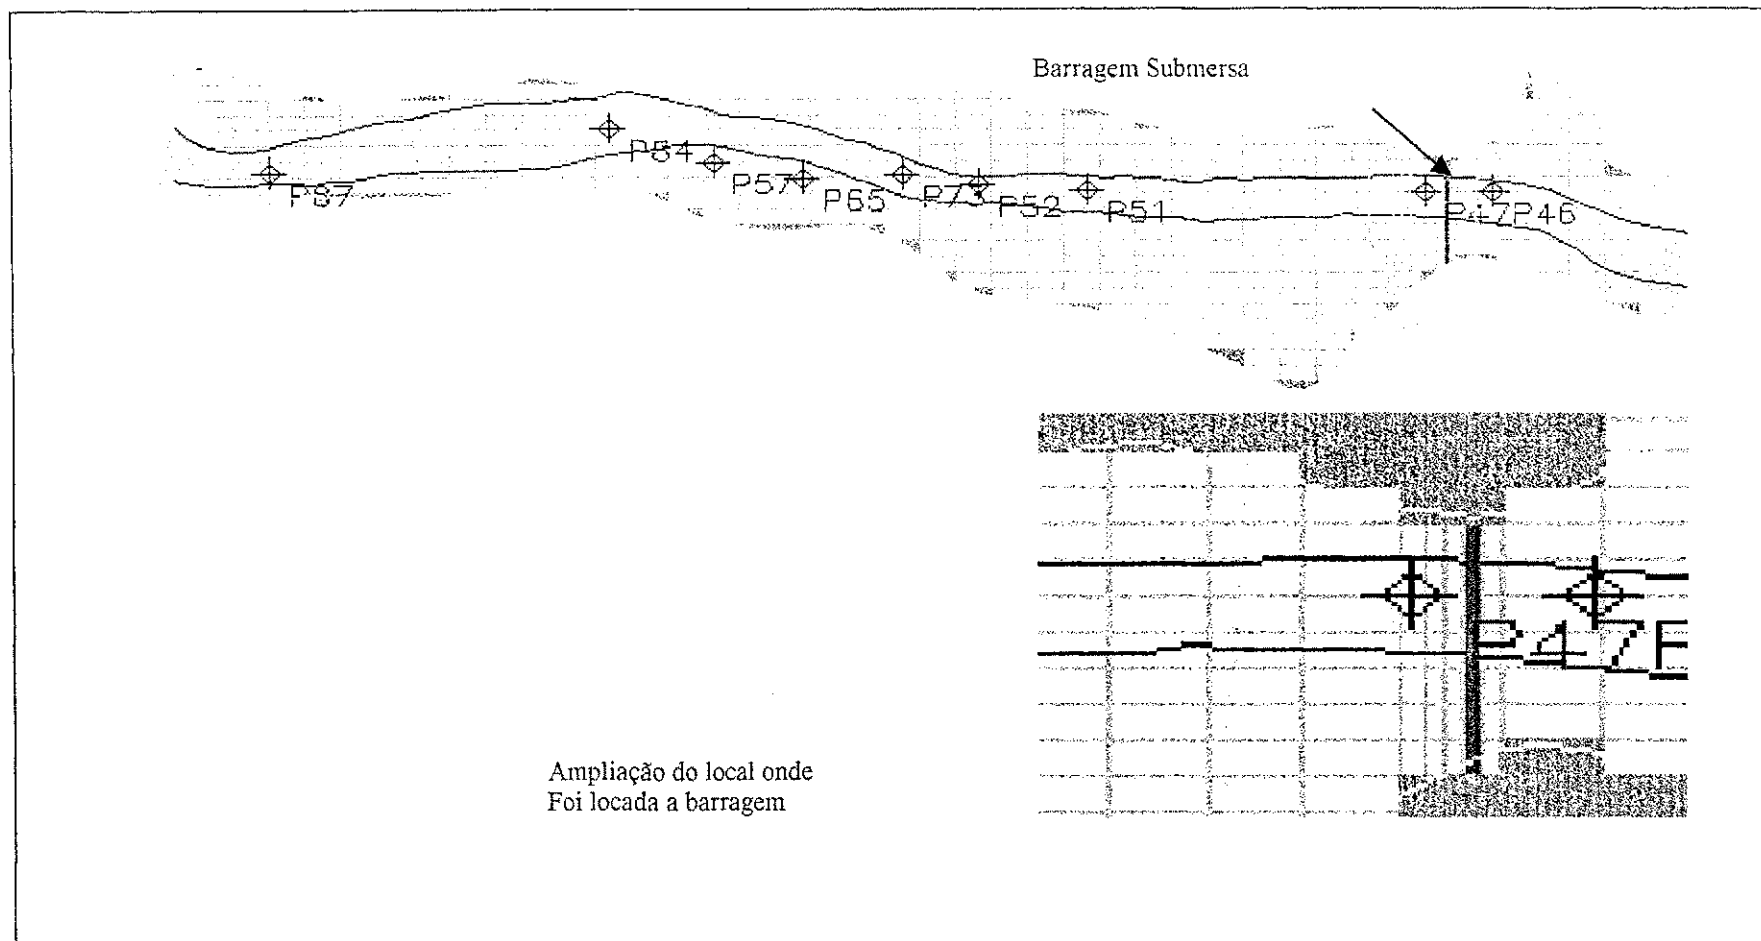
Localização da Barragem submersa na Área Modelada
